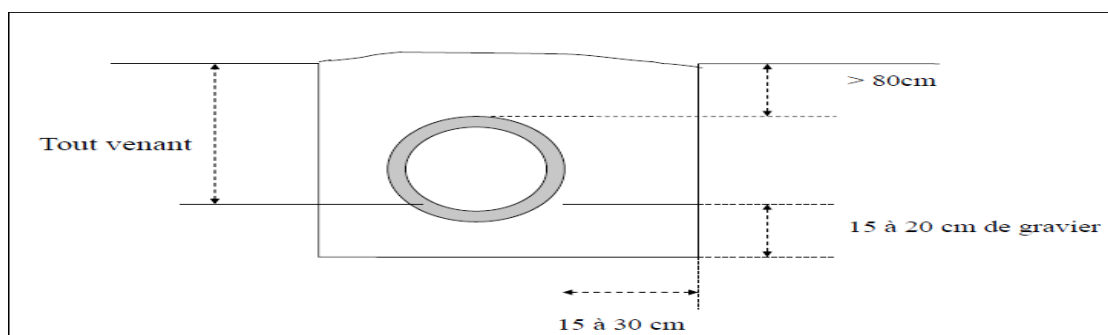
Pose de conduite en tranchée dans un terrain plat
